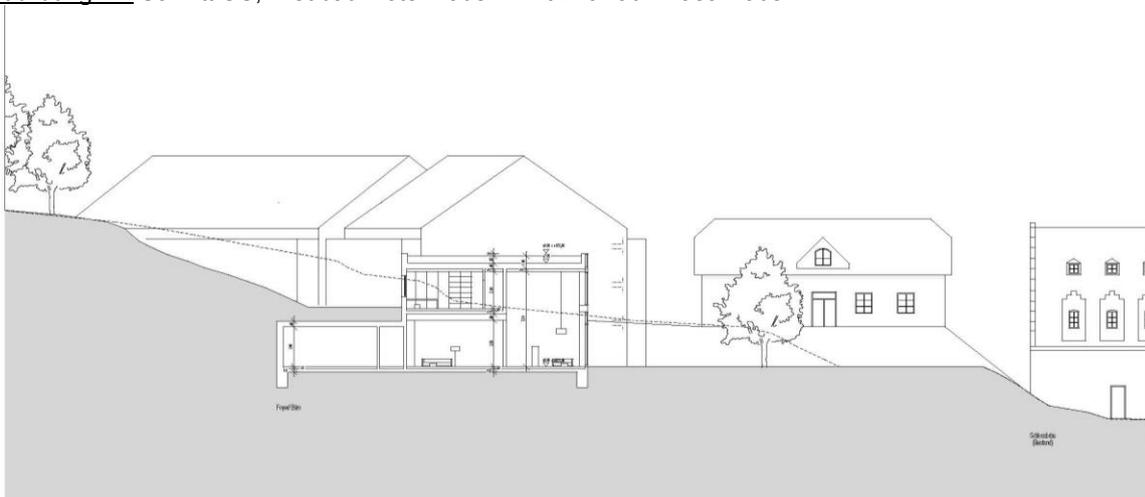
Schnitt DD, Empfangsgebäude, talseitig – Eingangsseite – eingeschossig, rückwärtiger Teil mit Nebenräumen teilweise zweigeschossig und Blick auf Neubau-Hotel Haus 1 und Haus 2 sowie rechter Rand das Schlossbräustüberl
